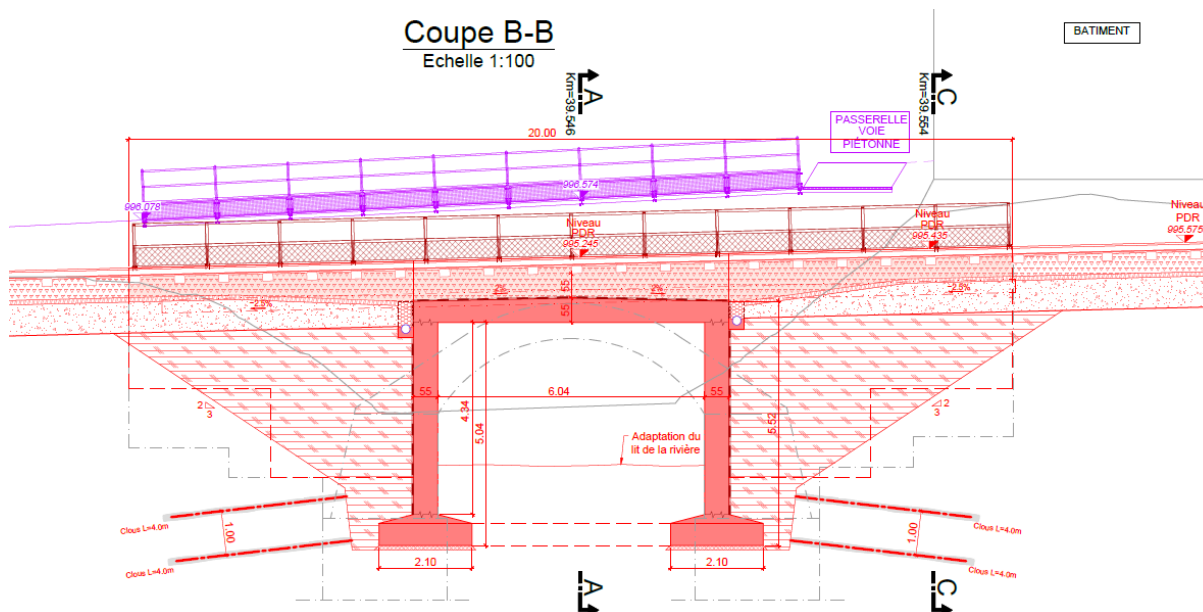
Coupe dans le pont de la Combabelle - extrait de plan
